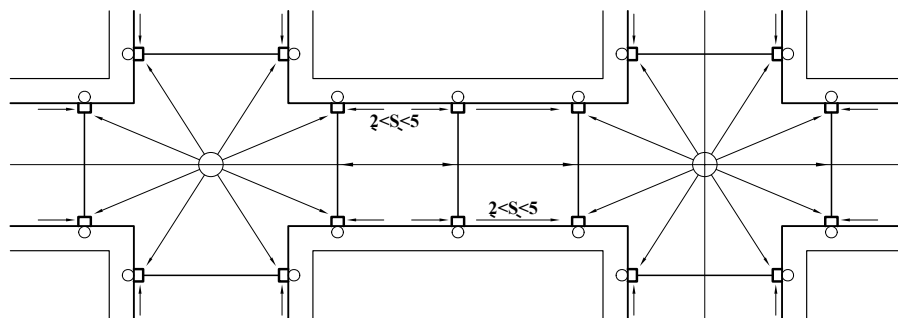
Ubicación de coladeras de piso y banqueta.
